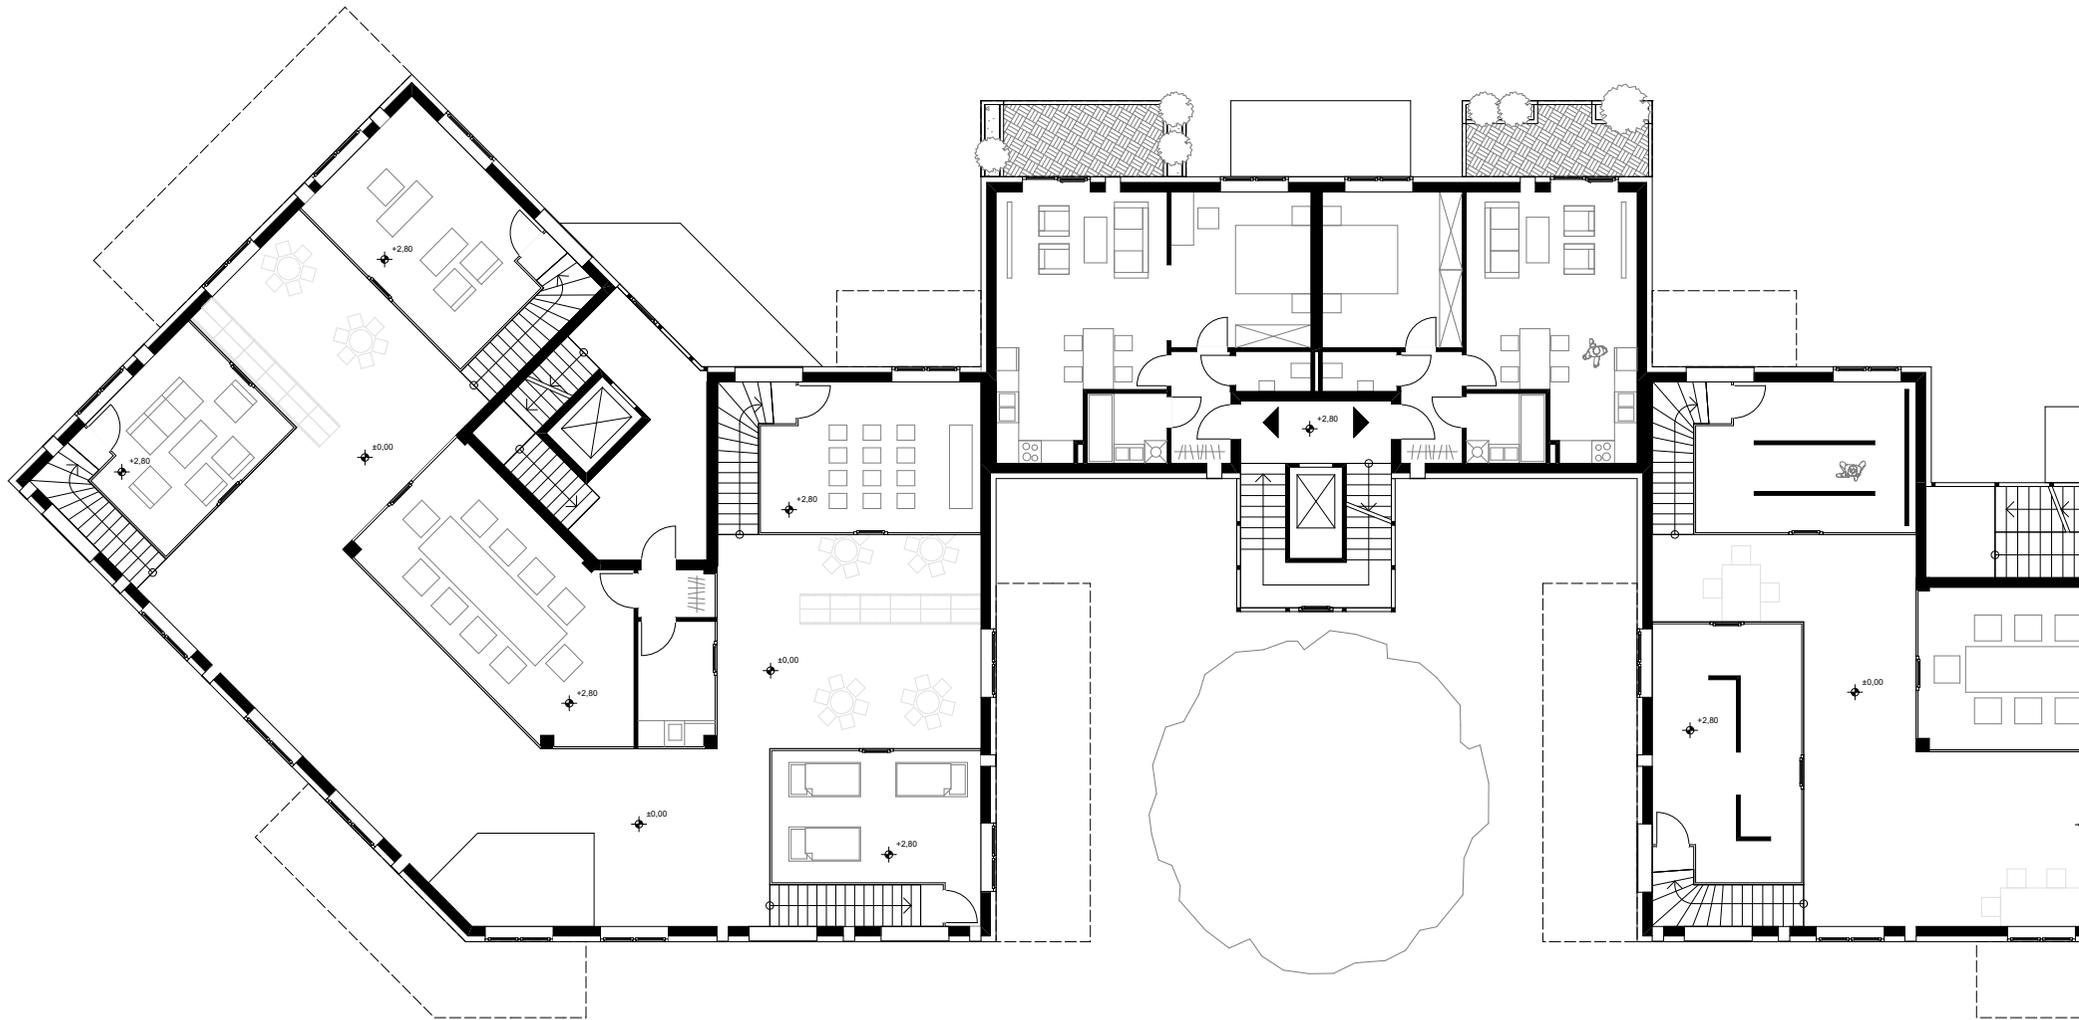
Grundriss Erdgeschoss - M 1:200
